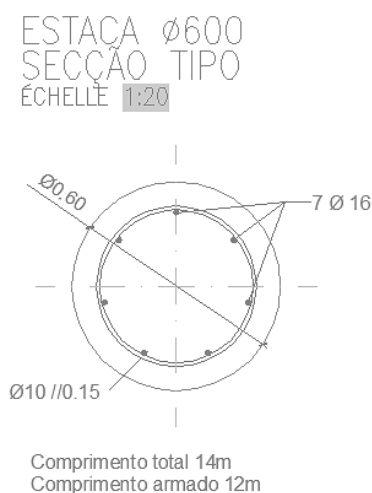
Pormenor da armadura da obra e ser estudada
